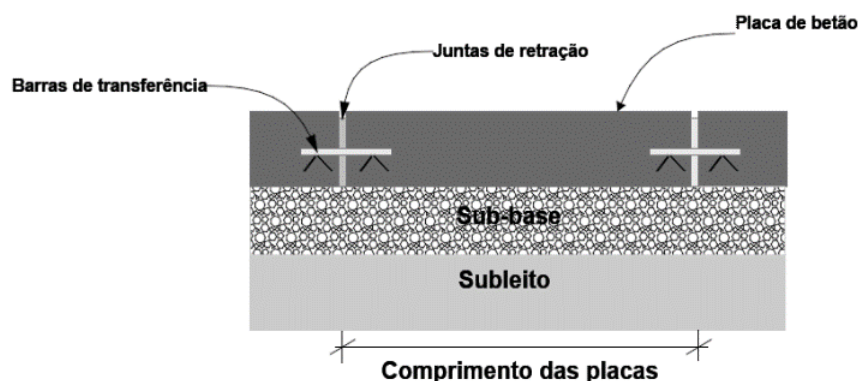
Estrutura do pavimento rígido (Fonte: autor, 2023).
